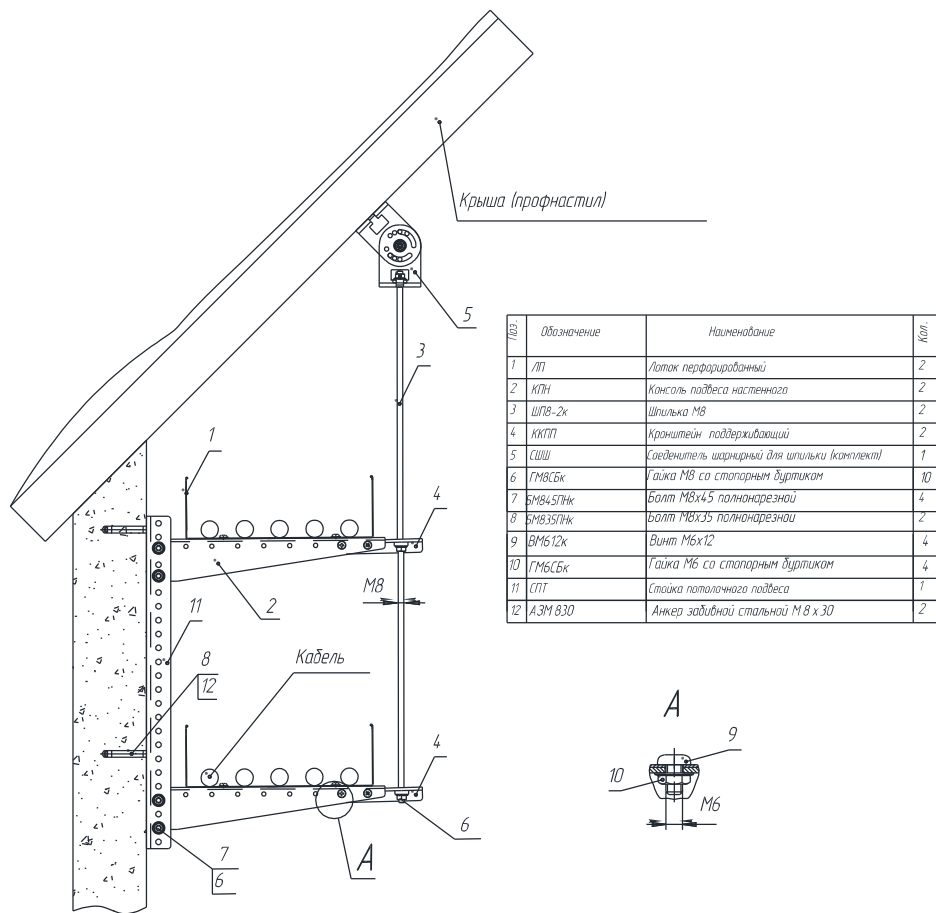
Крепление ОКЛ под углом к металлоконструкции (профнастилу) с помощью шарнирного соединителя СШШ
